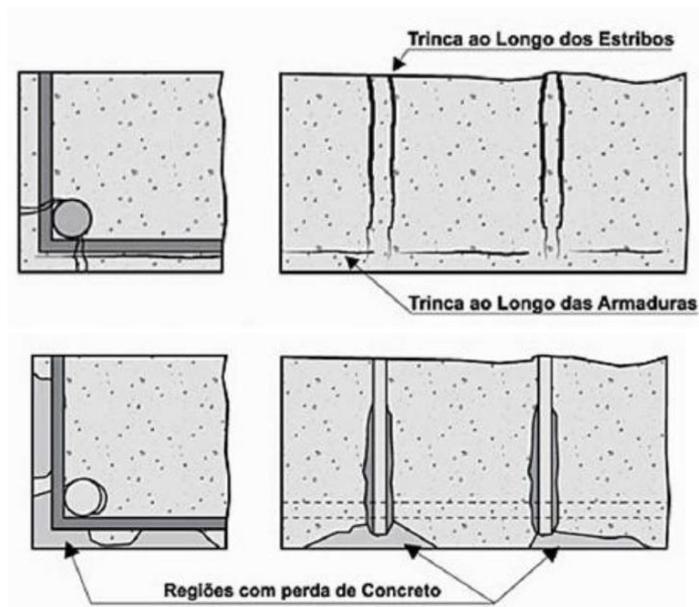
Fissura devido à corrosão das armaduras.
